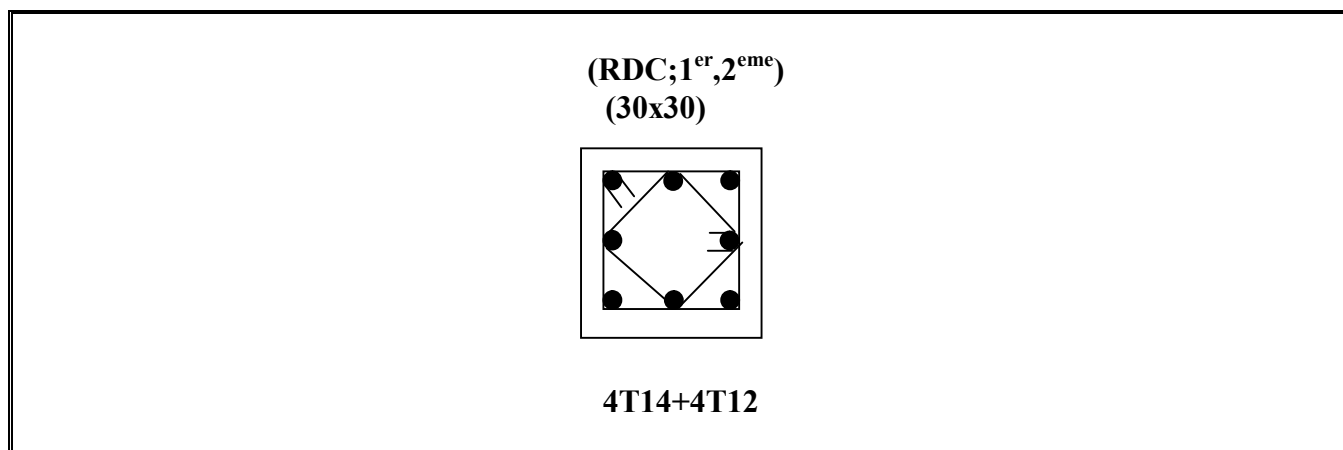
Dessin de ferrailages des sections des poteaux
